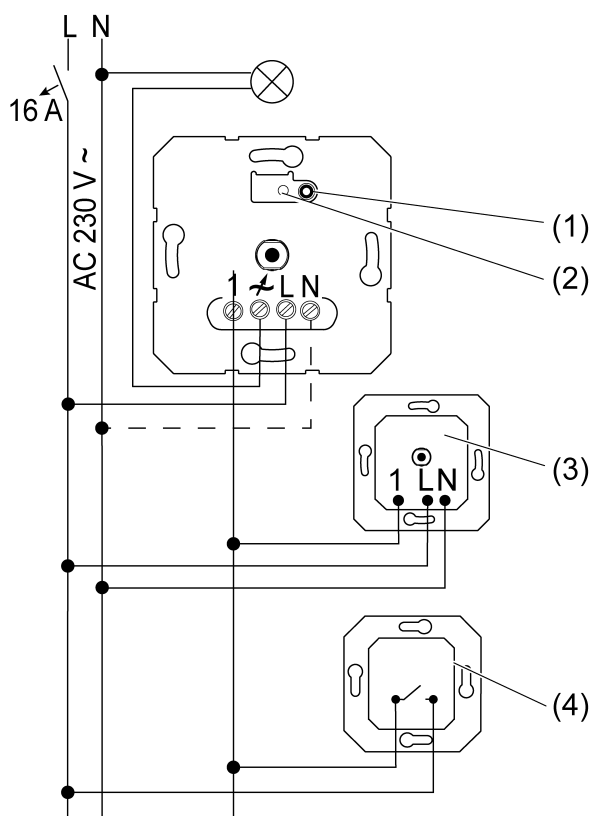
Plan de conexión con mecanismos auxiliares opcionales
